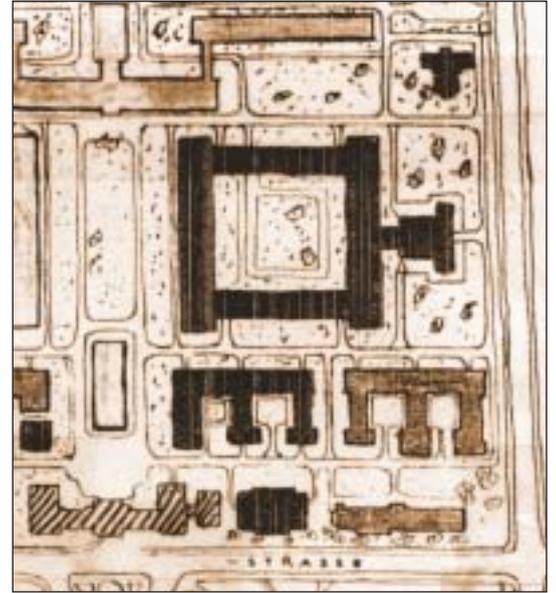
Ausschnitt des Lageplans des UKE von 1950 mit dem Bauplan für die Zahn- und Kieferklinik, (Gebäude oben).
